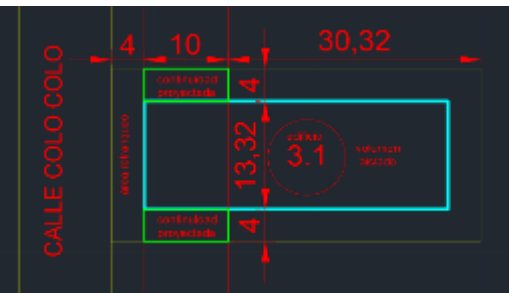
Planta de edificio. Fuente: elaboración propia.
